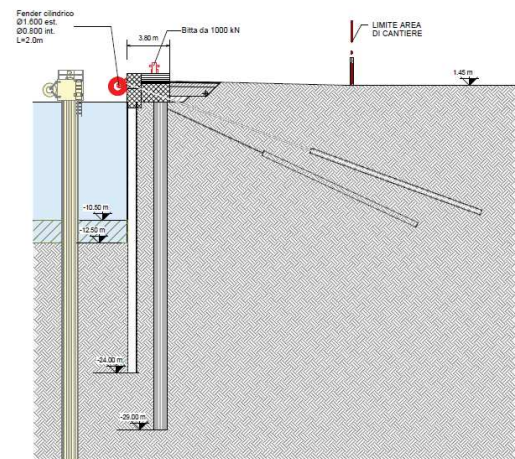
Sezione con indicazione dell'arredo da installare, la rimozione della briccola provvisoria e lo scavo fino a -12.50 m slmm
